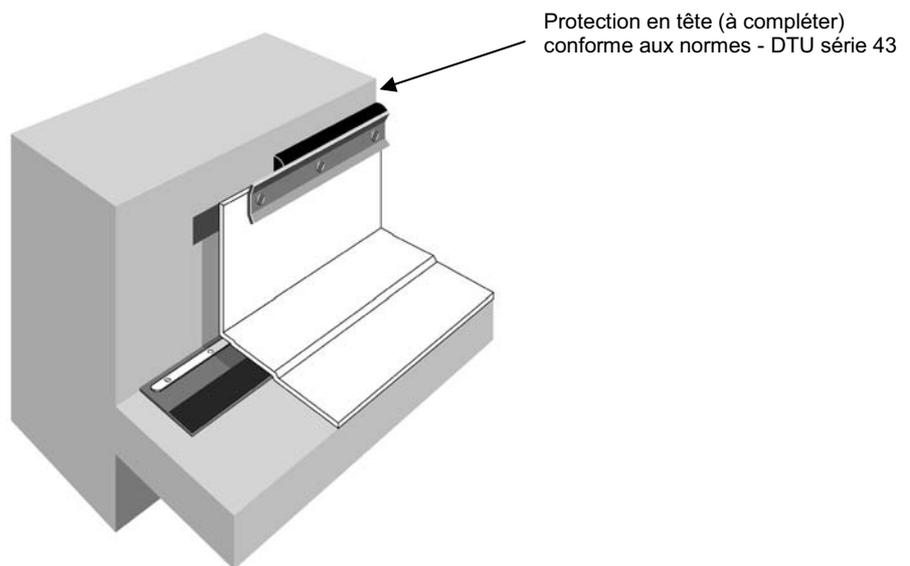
bis – Fixation d'embase par latte d'ancrage sur la membrane, recouvrement au QuickSeam FormFlash
